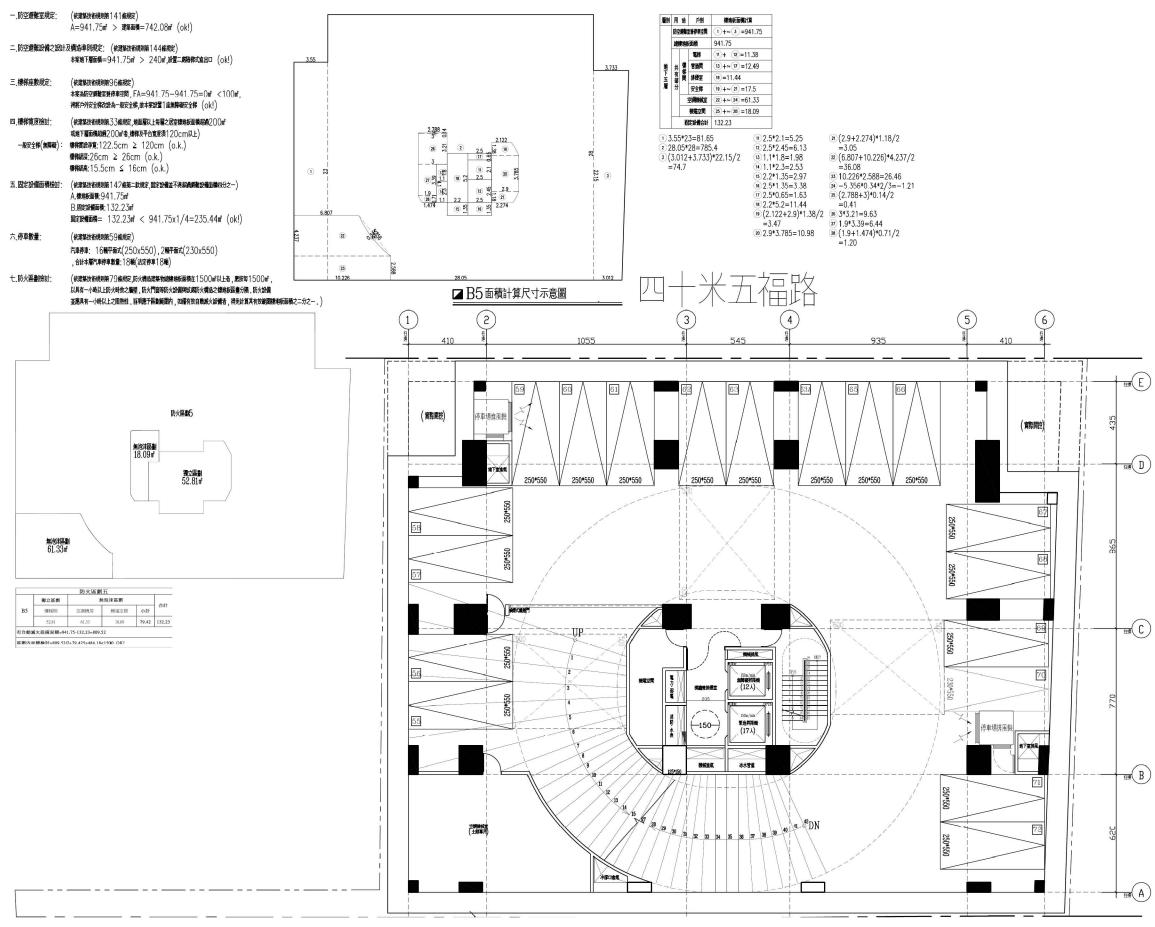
地下 5 層平面圖 (比例尺 1/200)
